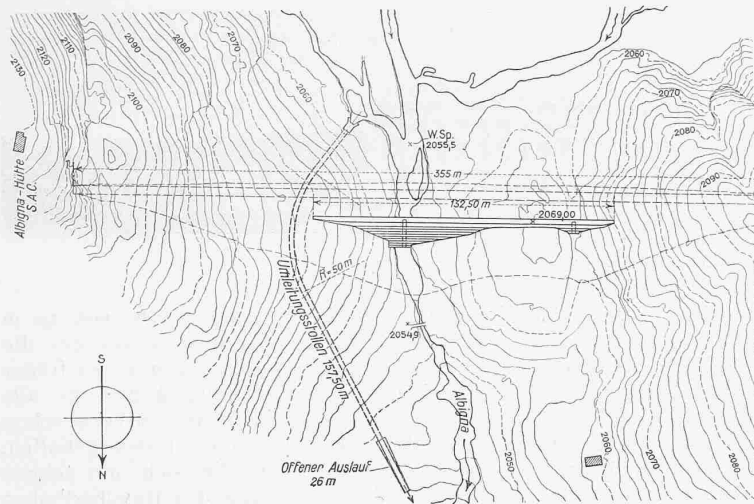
Grundriss der Hochwasserschutz-Mauer für 2,9 Mill. m<sup>3</sup> Retentionsraum. Masstab 1 : 3000. Gestrichelt: Definitive Staumauer.
